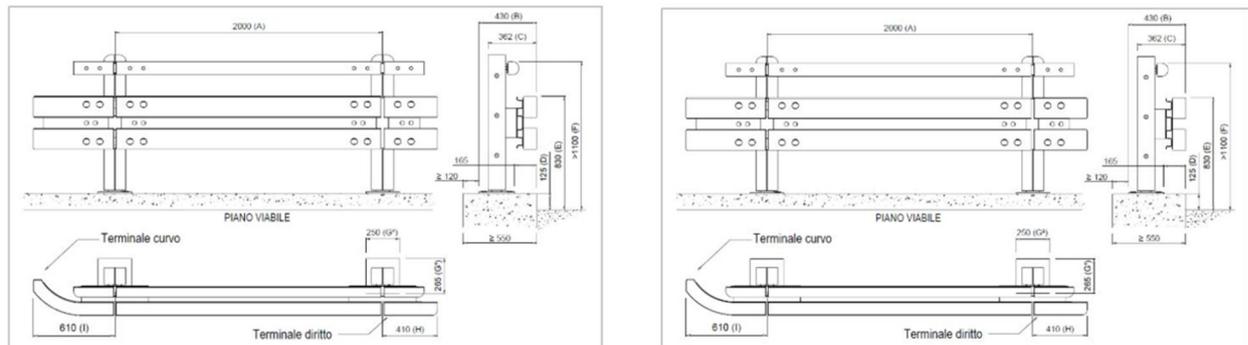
Pianta, prospetto e sezione tipo della barriera H1 BL e H2 BP in legno e Corten
